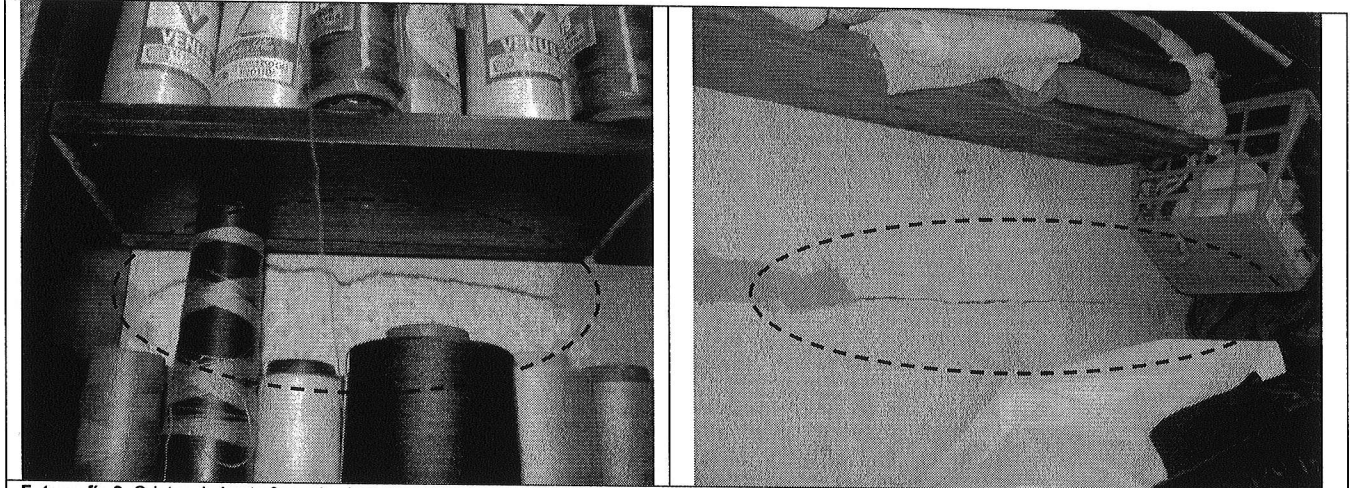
Grietas de hasta 1.4 mm de abertura con tendencia vertical en el muro de cerramiento posterior hacia las esquinas donde este muro se une con los muros laterales, indicando un posible movimiento diferencial de la cimentación de este muro
